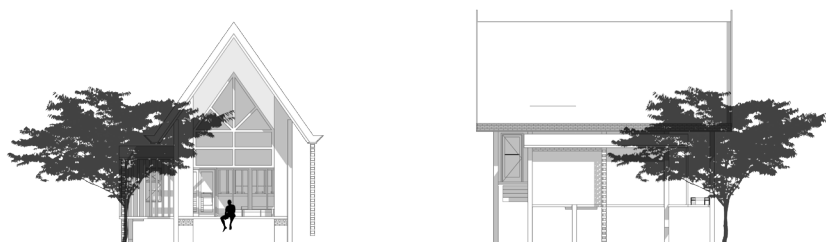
Perspektif Bangunan Deluxe Villa
